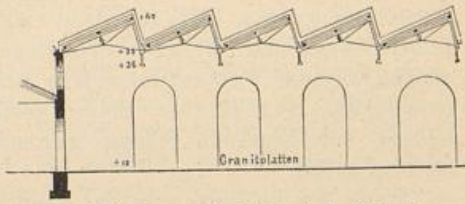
Längenschnitt durch die Schmiede. (3, Fig. 119.)
